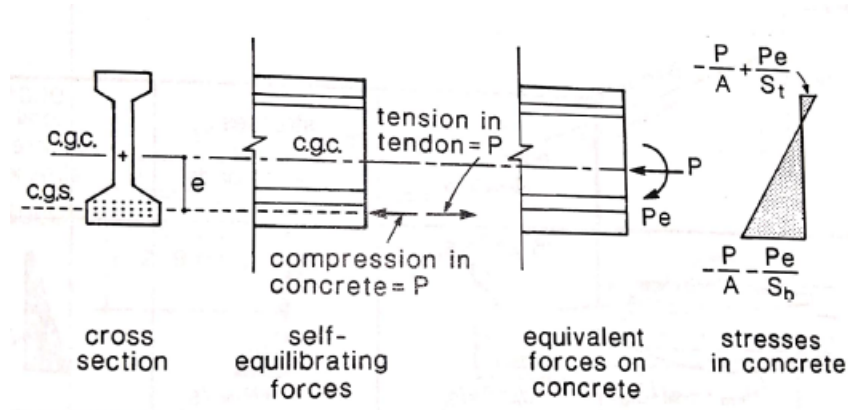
Fuerzas auto-equilibrantes en el concreto presforzado [18]
